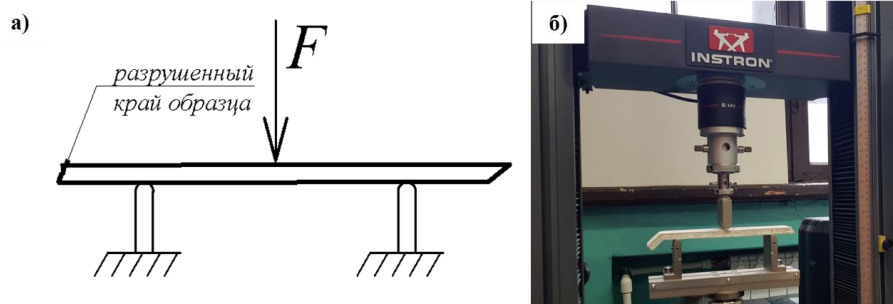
Испытание образцов из текстильно-армированного бетона на изгиб: а) схема нагружения; б) вид образца перед испытанием
